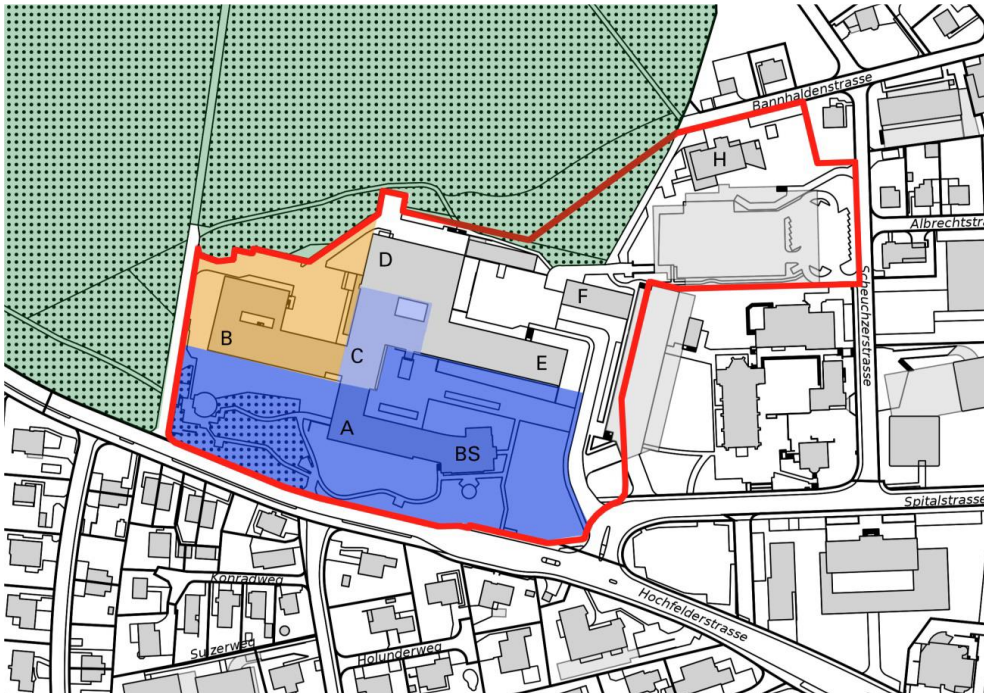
Perimeterplan (Quelle Plan: Amtliche Vermessung, GIS-ZH, Kanton Zürich)
